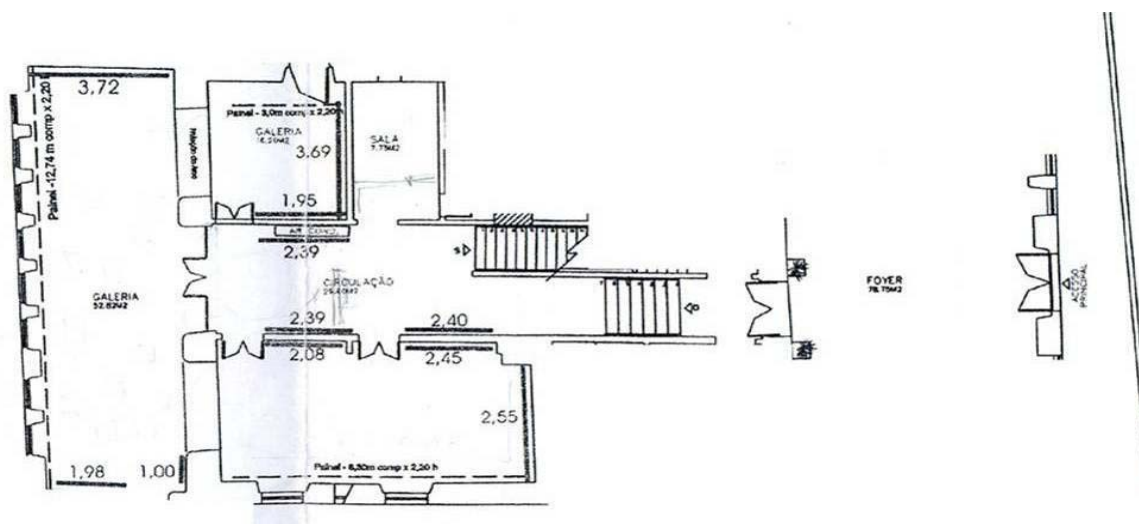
Maristela Ribeiro. Planta baixa das galerias do pavimento térreo do Conjunto Cultural da Caixa. 2004
